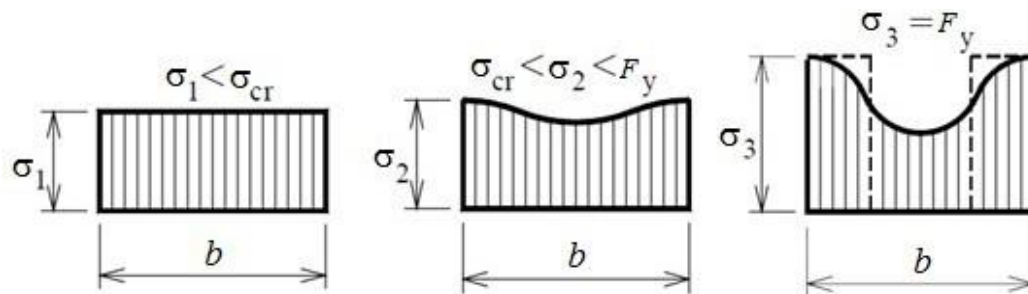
Desarrollo de la distribución de tensiones de un elemento plano rigidizado sometido a compresión
